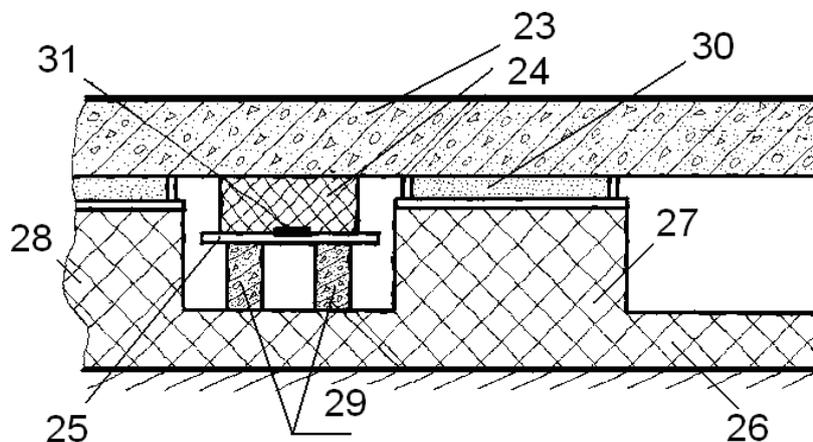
Схема виброизоляции железобетонной плиты в основании здания
